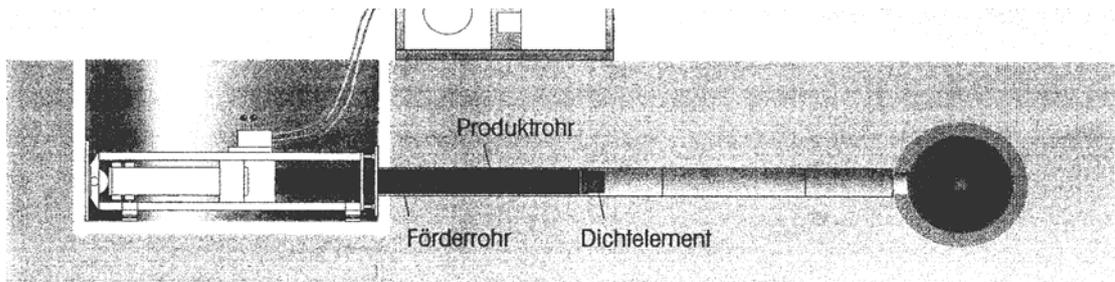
Einschieben der Produktrohre mit Dichtelement [1]
